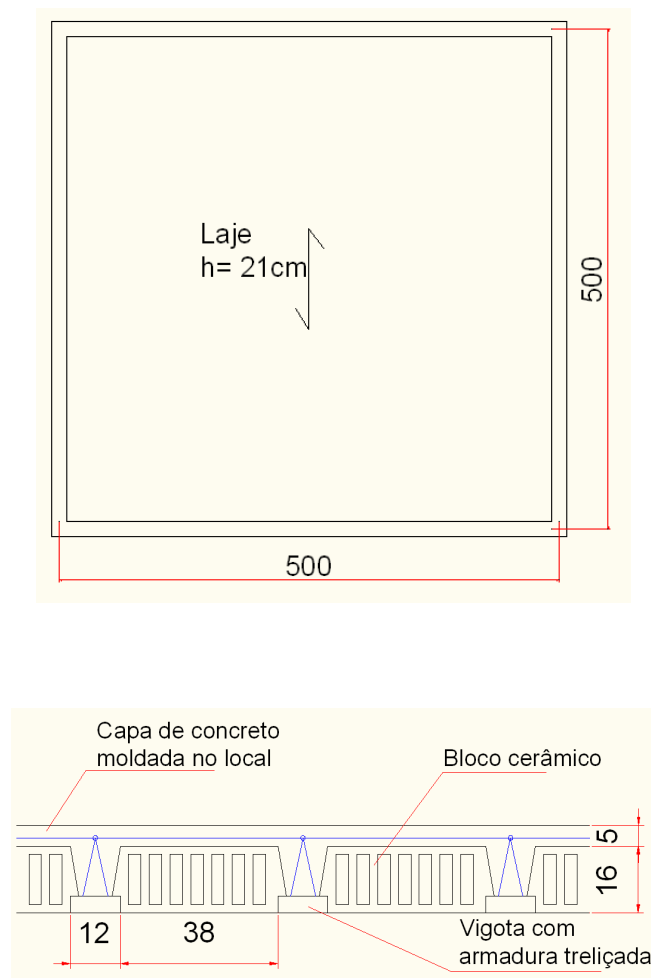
Características do pavimento a ser estudado inicialmente. Planta e seção transversal do elemento longitudinal.
